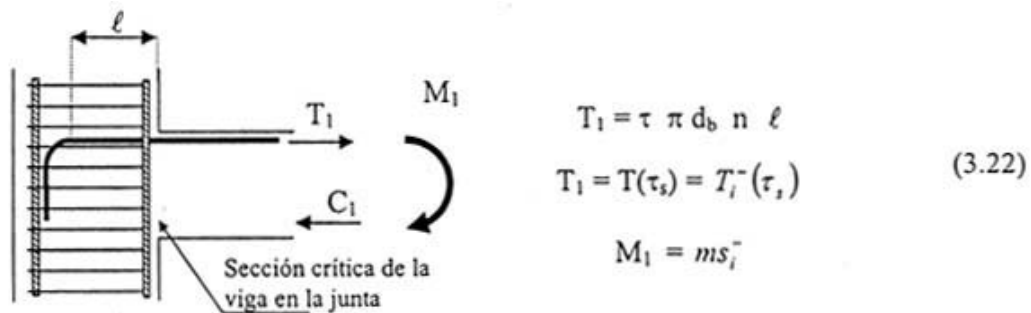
Longitud de anclaje adoptada en el modelo de daño concentrado con deslizamiento en juntas viga plana-columna.
